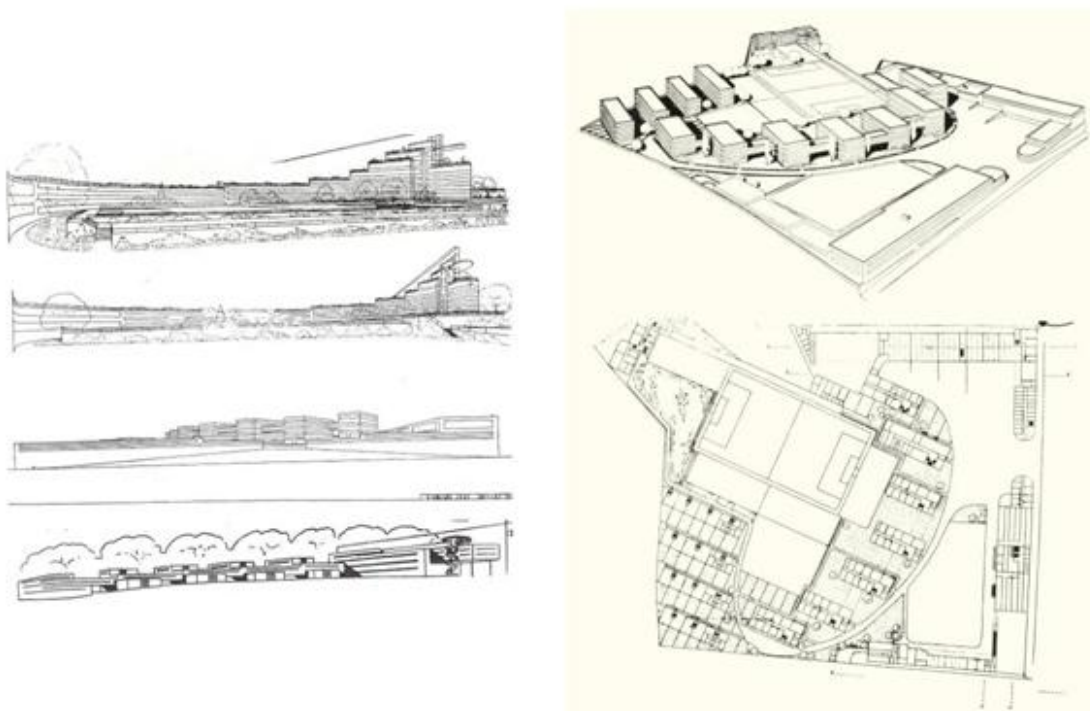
Links: Rothers zweiter Vorschlag für den Wettbewerb in Essen. 134 Rechts: Rothers dritter Vorschlag für den Wettbewerb in Essen. Perspektive und Grundriss.
